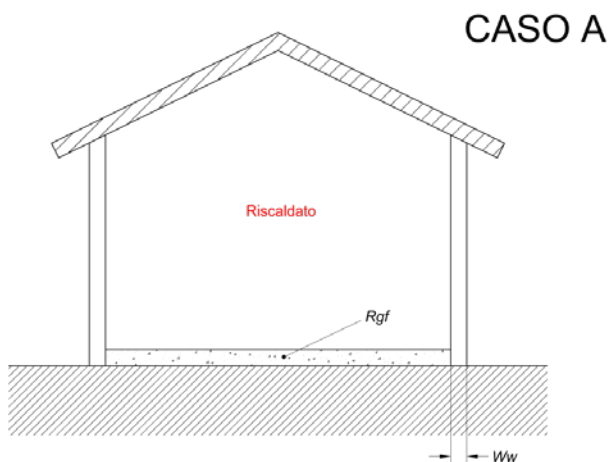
Basamento CASO A –Pavimento su terreno
